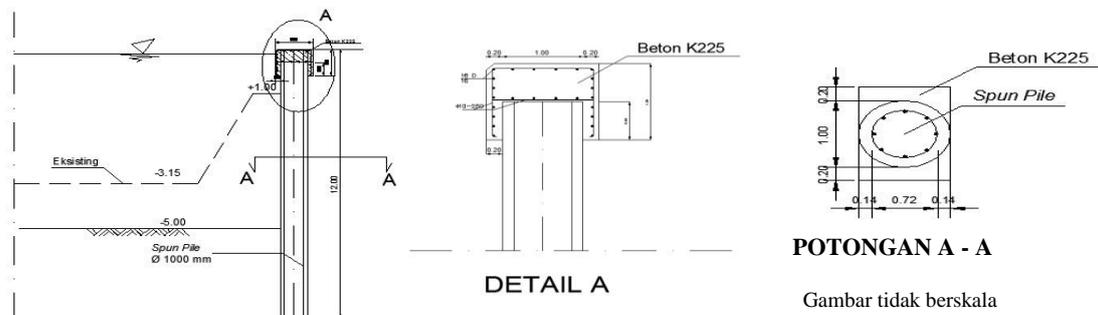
Denah dan Desain Rencana *Spillway* (Potongan A-A)
